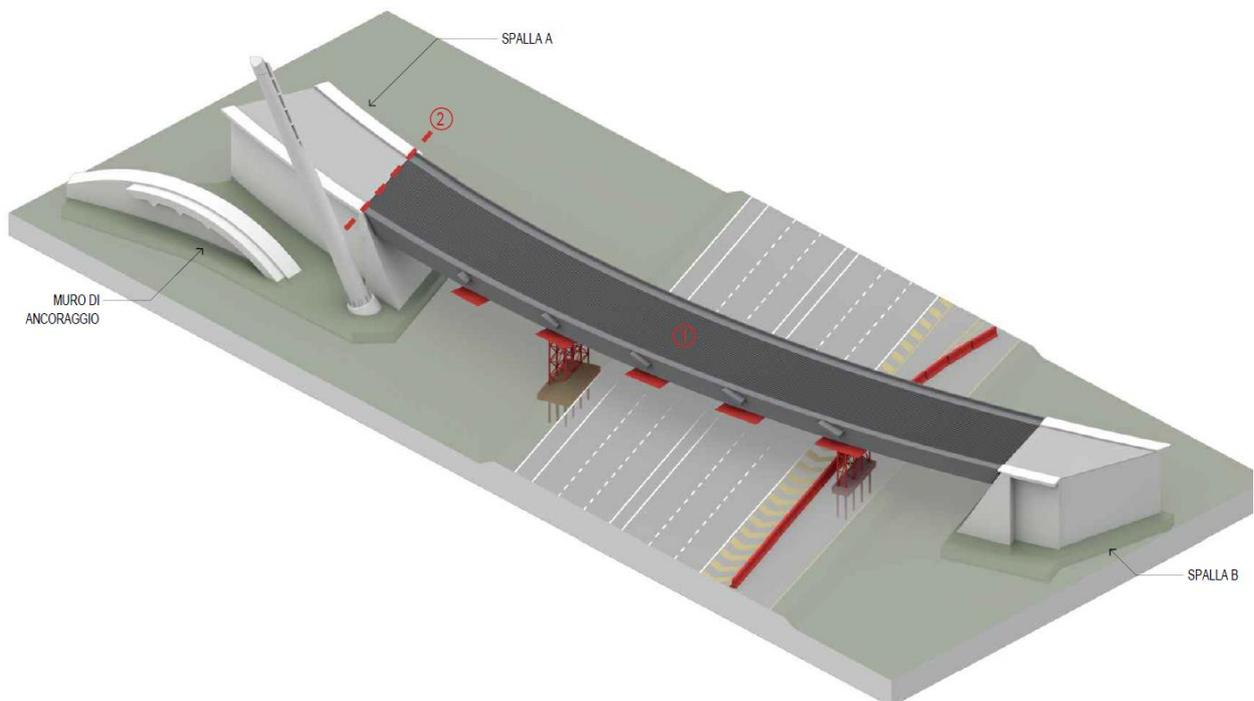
Montaggio dell'impalcato e solidarizzazione alla spalla A.
